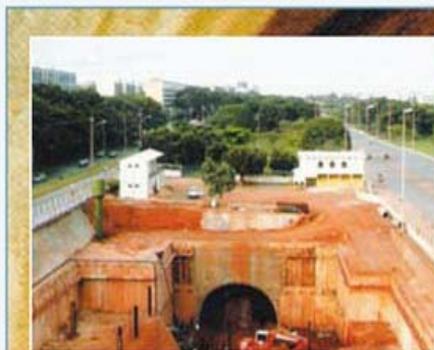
Vista de estação na Asa Sul, com emboque do túnel já escavado - Metrô DF (CBT, 2006)
